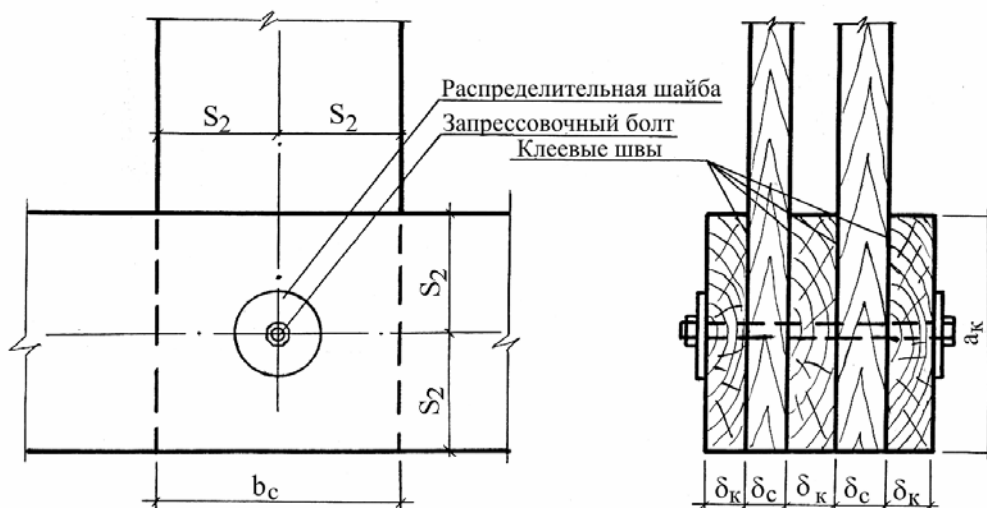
Бесфасоночное соединение с болтовой запрессовкой
